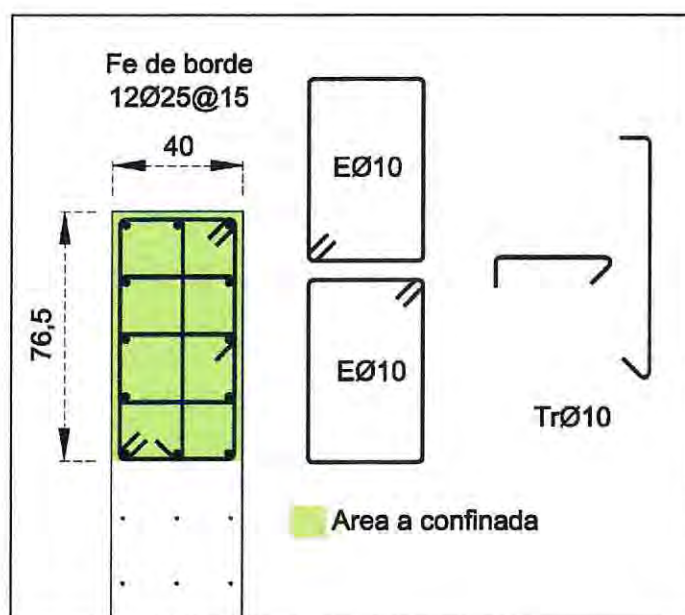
Elementos de confinamiento, alas comprimidas muro "C"
